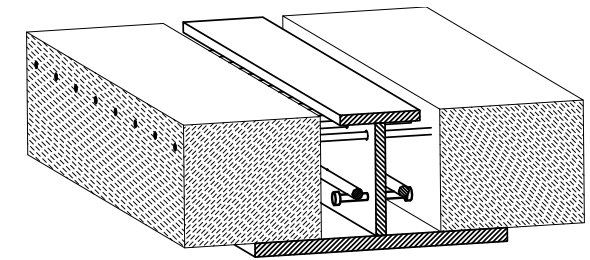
Mittelträger mit Decke, Bewehrung und Kopfbolzen
